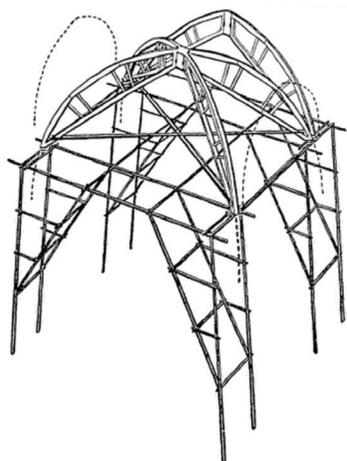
Cimbras y andamiaje para la construcción de una bóveda de crucería. Dibujo de Fitchen (The Construction of Gothic Cathedrals). [Rabasa, 2000, p.72]
